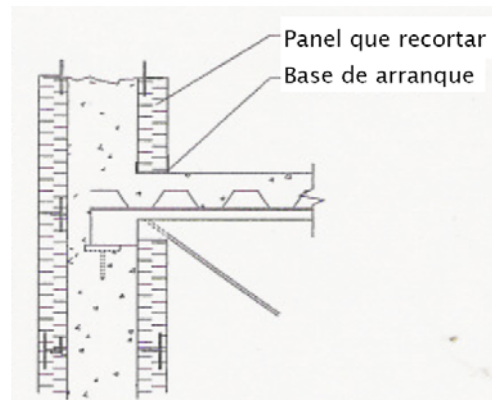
a. Alineamiento de los paneles de bordes sobre la losa de concreto
